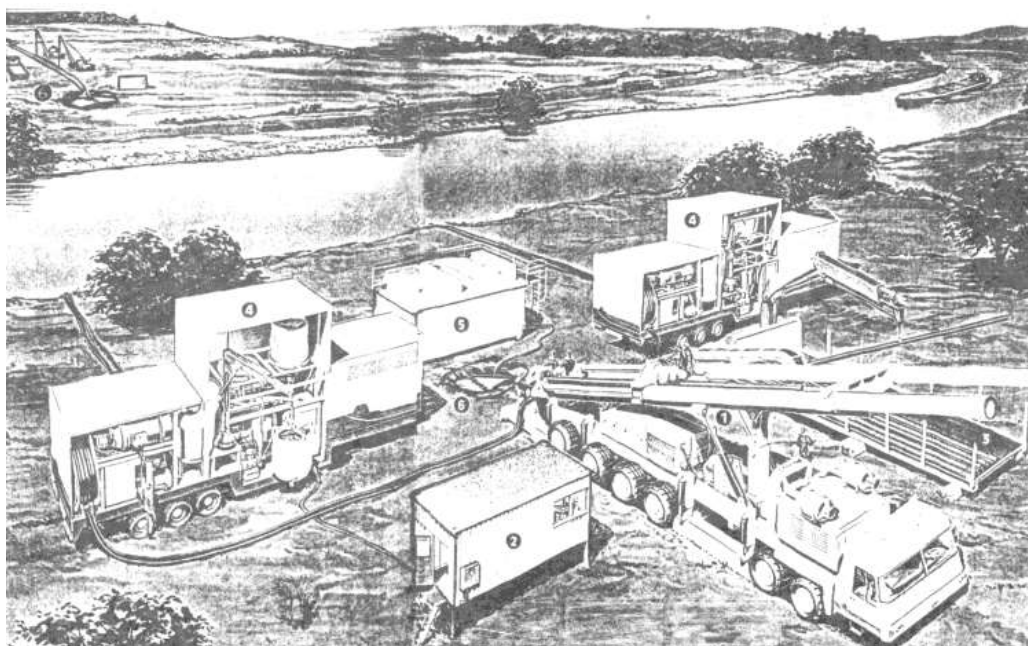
Схема размещения оборудования на строительной площадке при ННБ:
